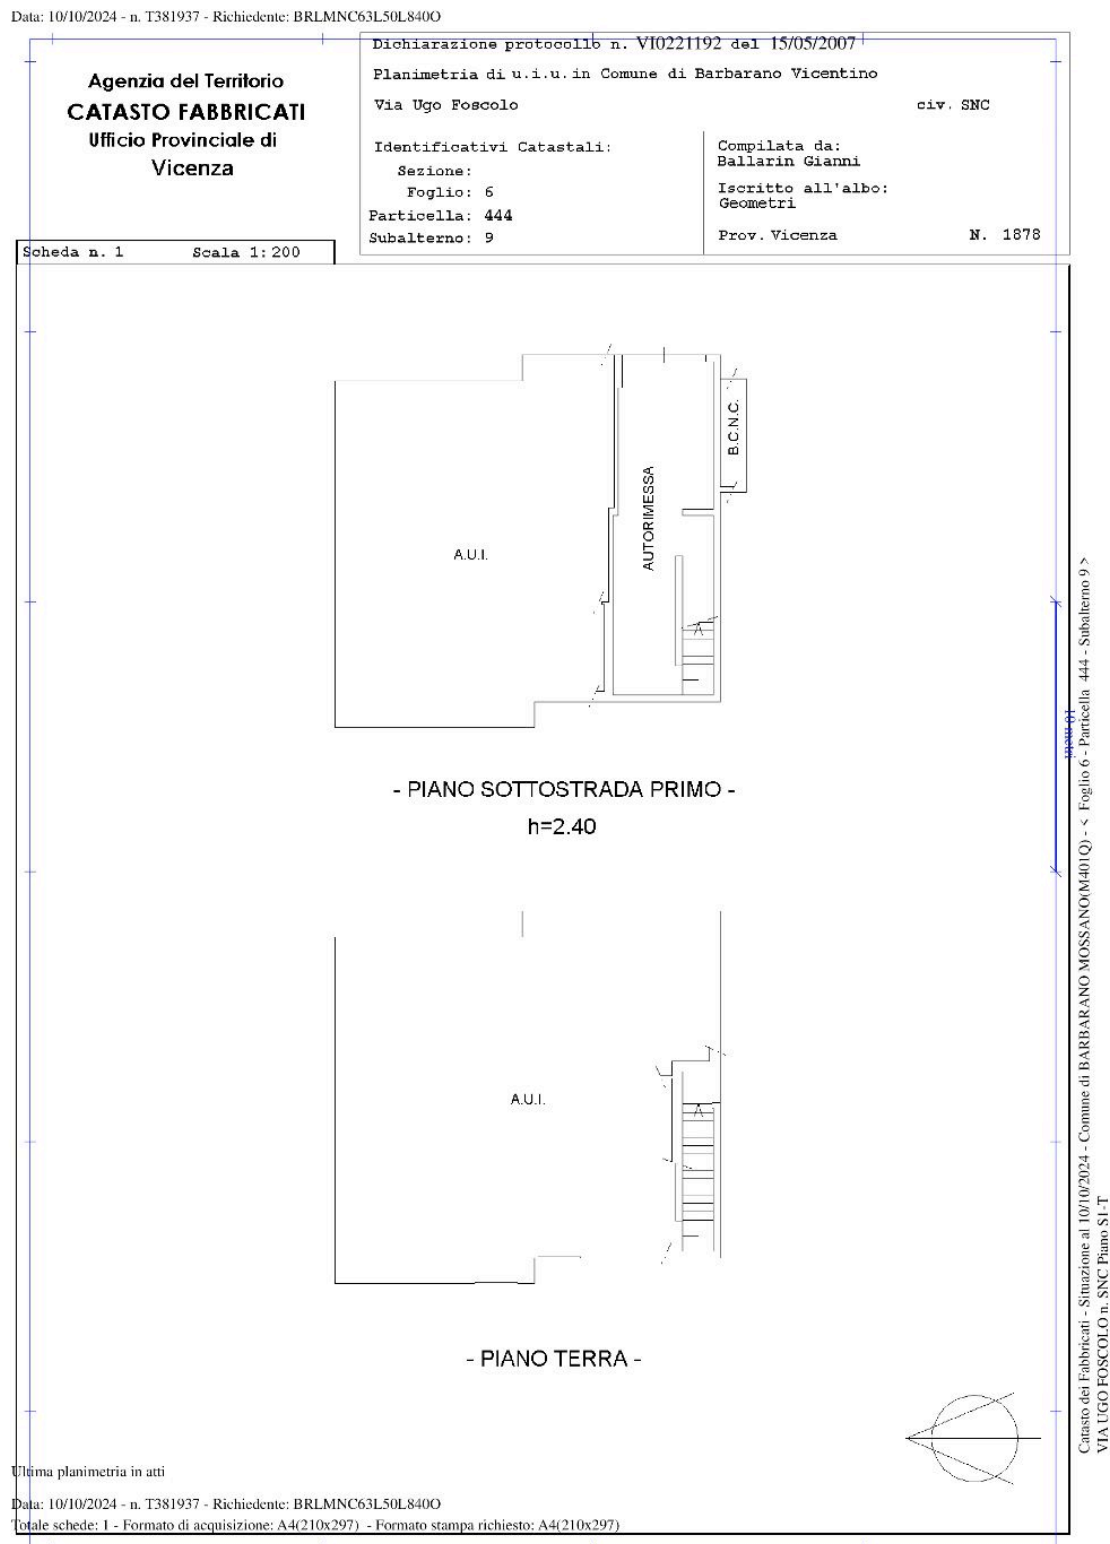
Estratto planimetria catastale map. 444 sub. 9 – elaborato non in scala
